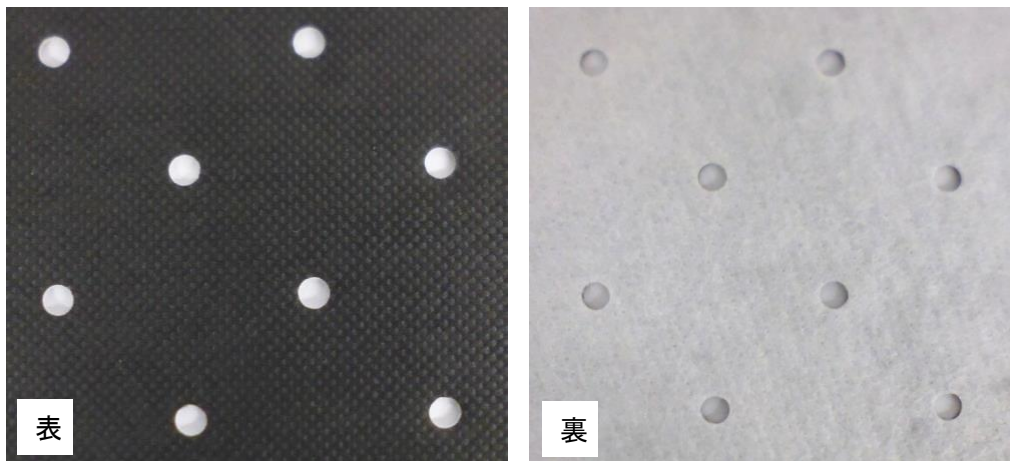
通気緩衝シートA (穴あき不織布タイプ)
